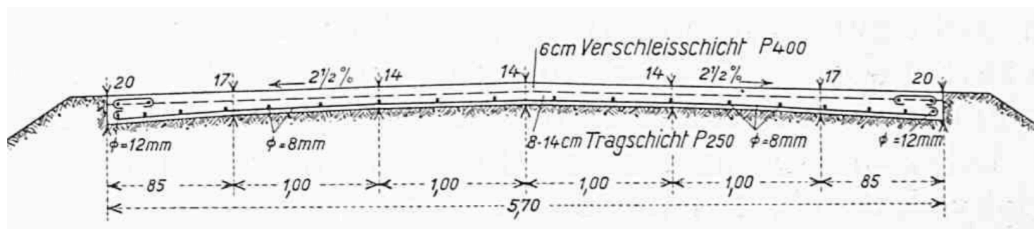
Detailaufbau einer Betonstrasse mit sechs Zentimeter starker Verschleisssschicht aus dem Bericht von Nörbel. Klar zu erkennen ist die Trennung zur tragenden Struktur.
